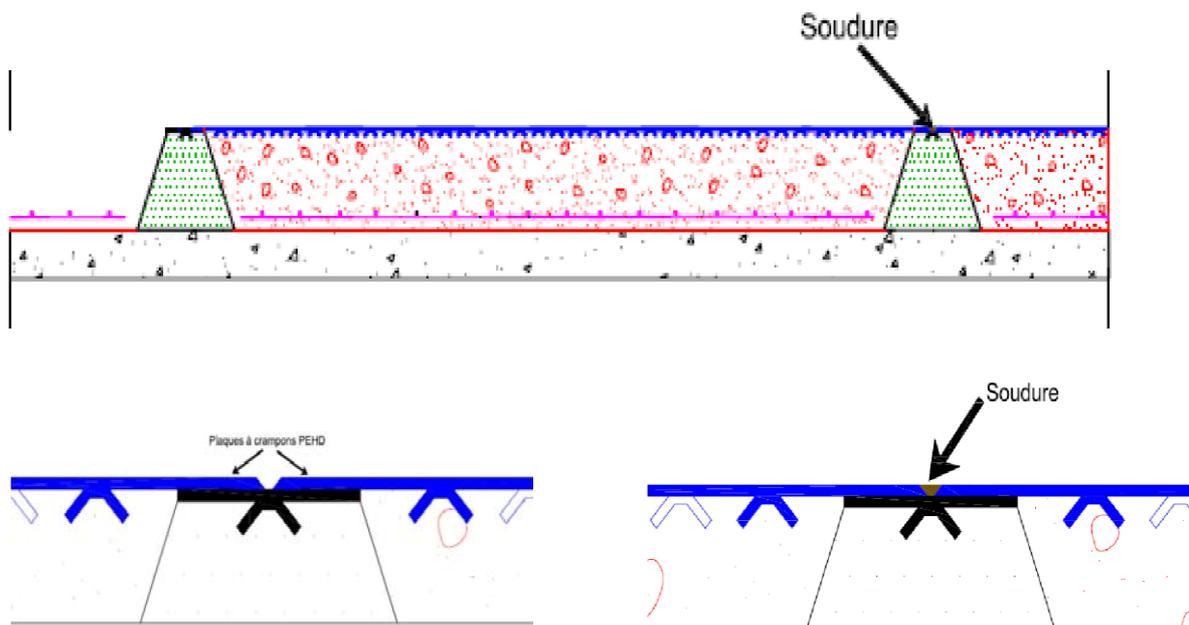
Grattage au droit des parties à souder puis soudure
